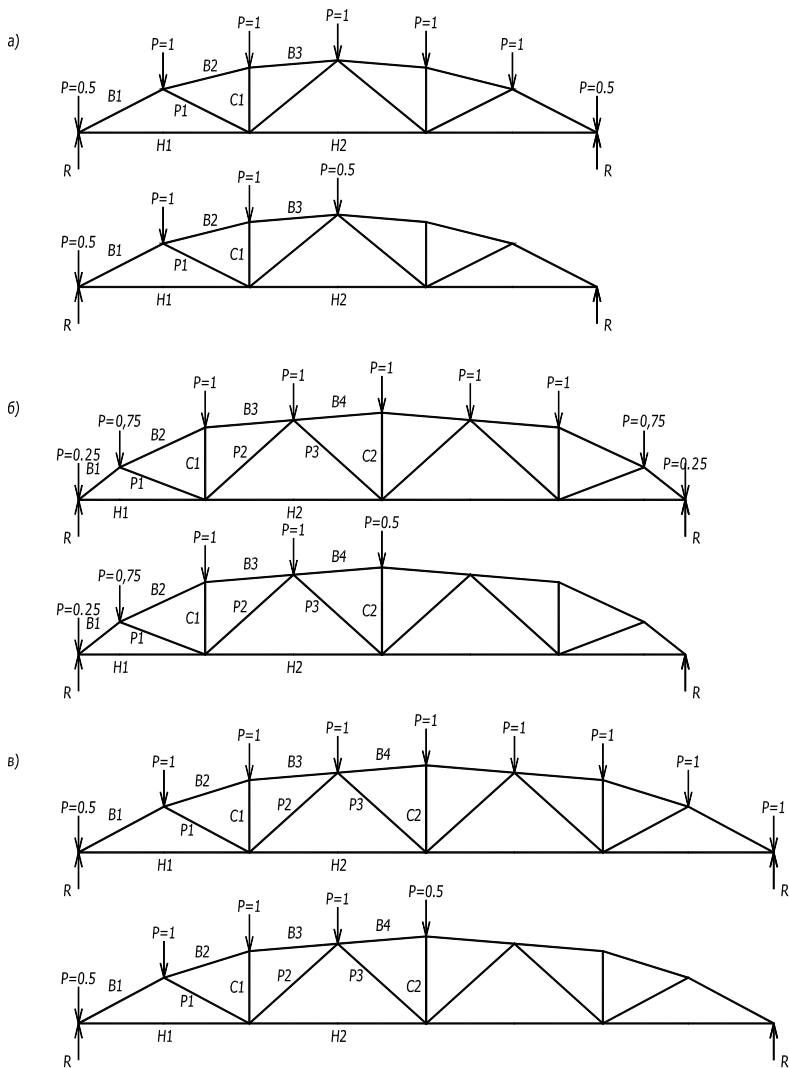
Нумерация элементов и схемы нагружения единичной нагрузкой: а – фермы пролетом 18 м; б – фермы пролетом 21 м; в – фермы пролетом 24 м.
